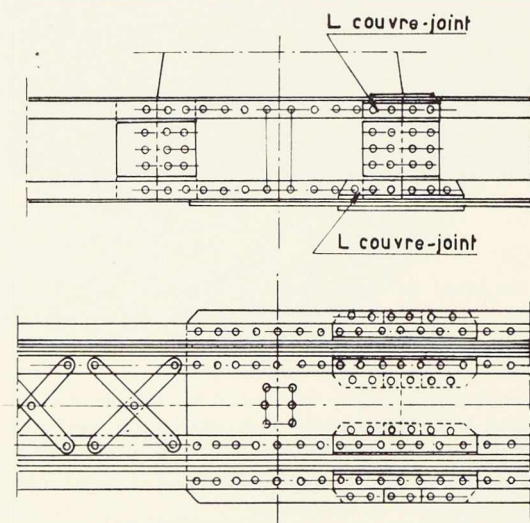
Détails constructifs de la membrure inférieure des maîtresses-poutres.
